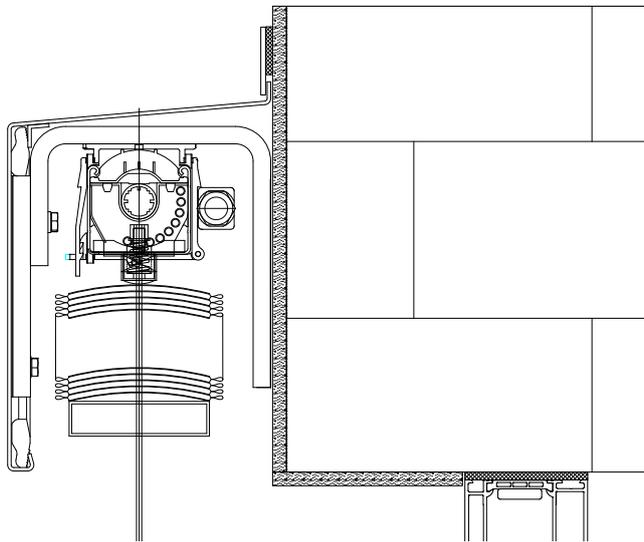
Raffstoreblende mit Winkel und Überfangblech
